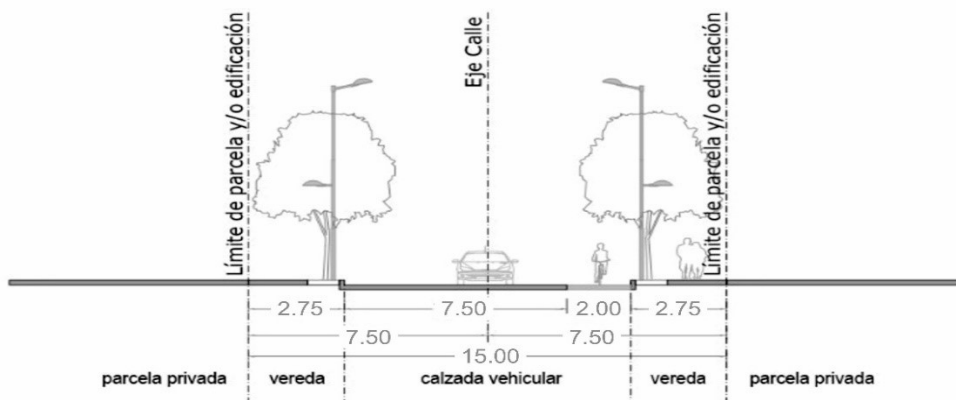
Sección transversal de Vías Especiales Tipo 4.
